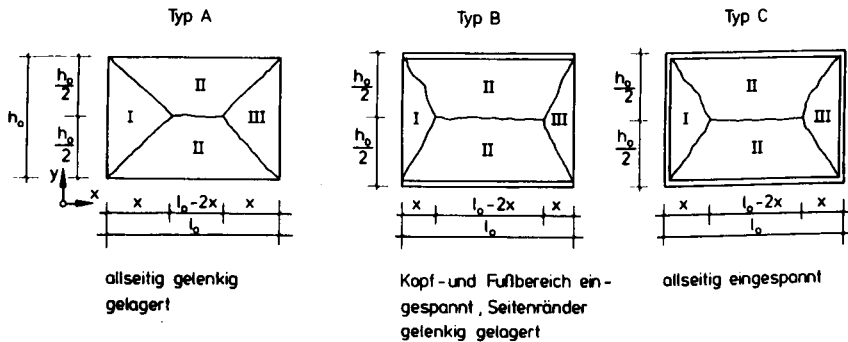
Bruchlinienfiguren kreuzweise lastabtragender Mauerwerkswände
